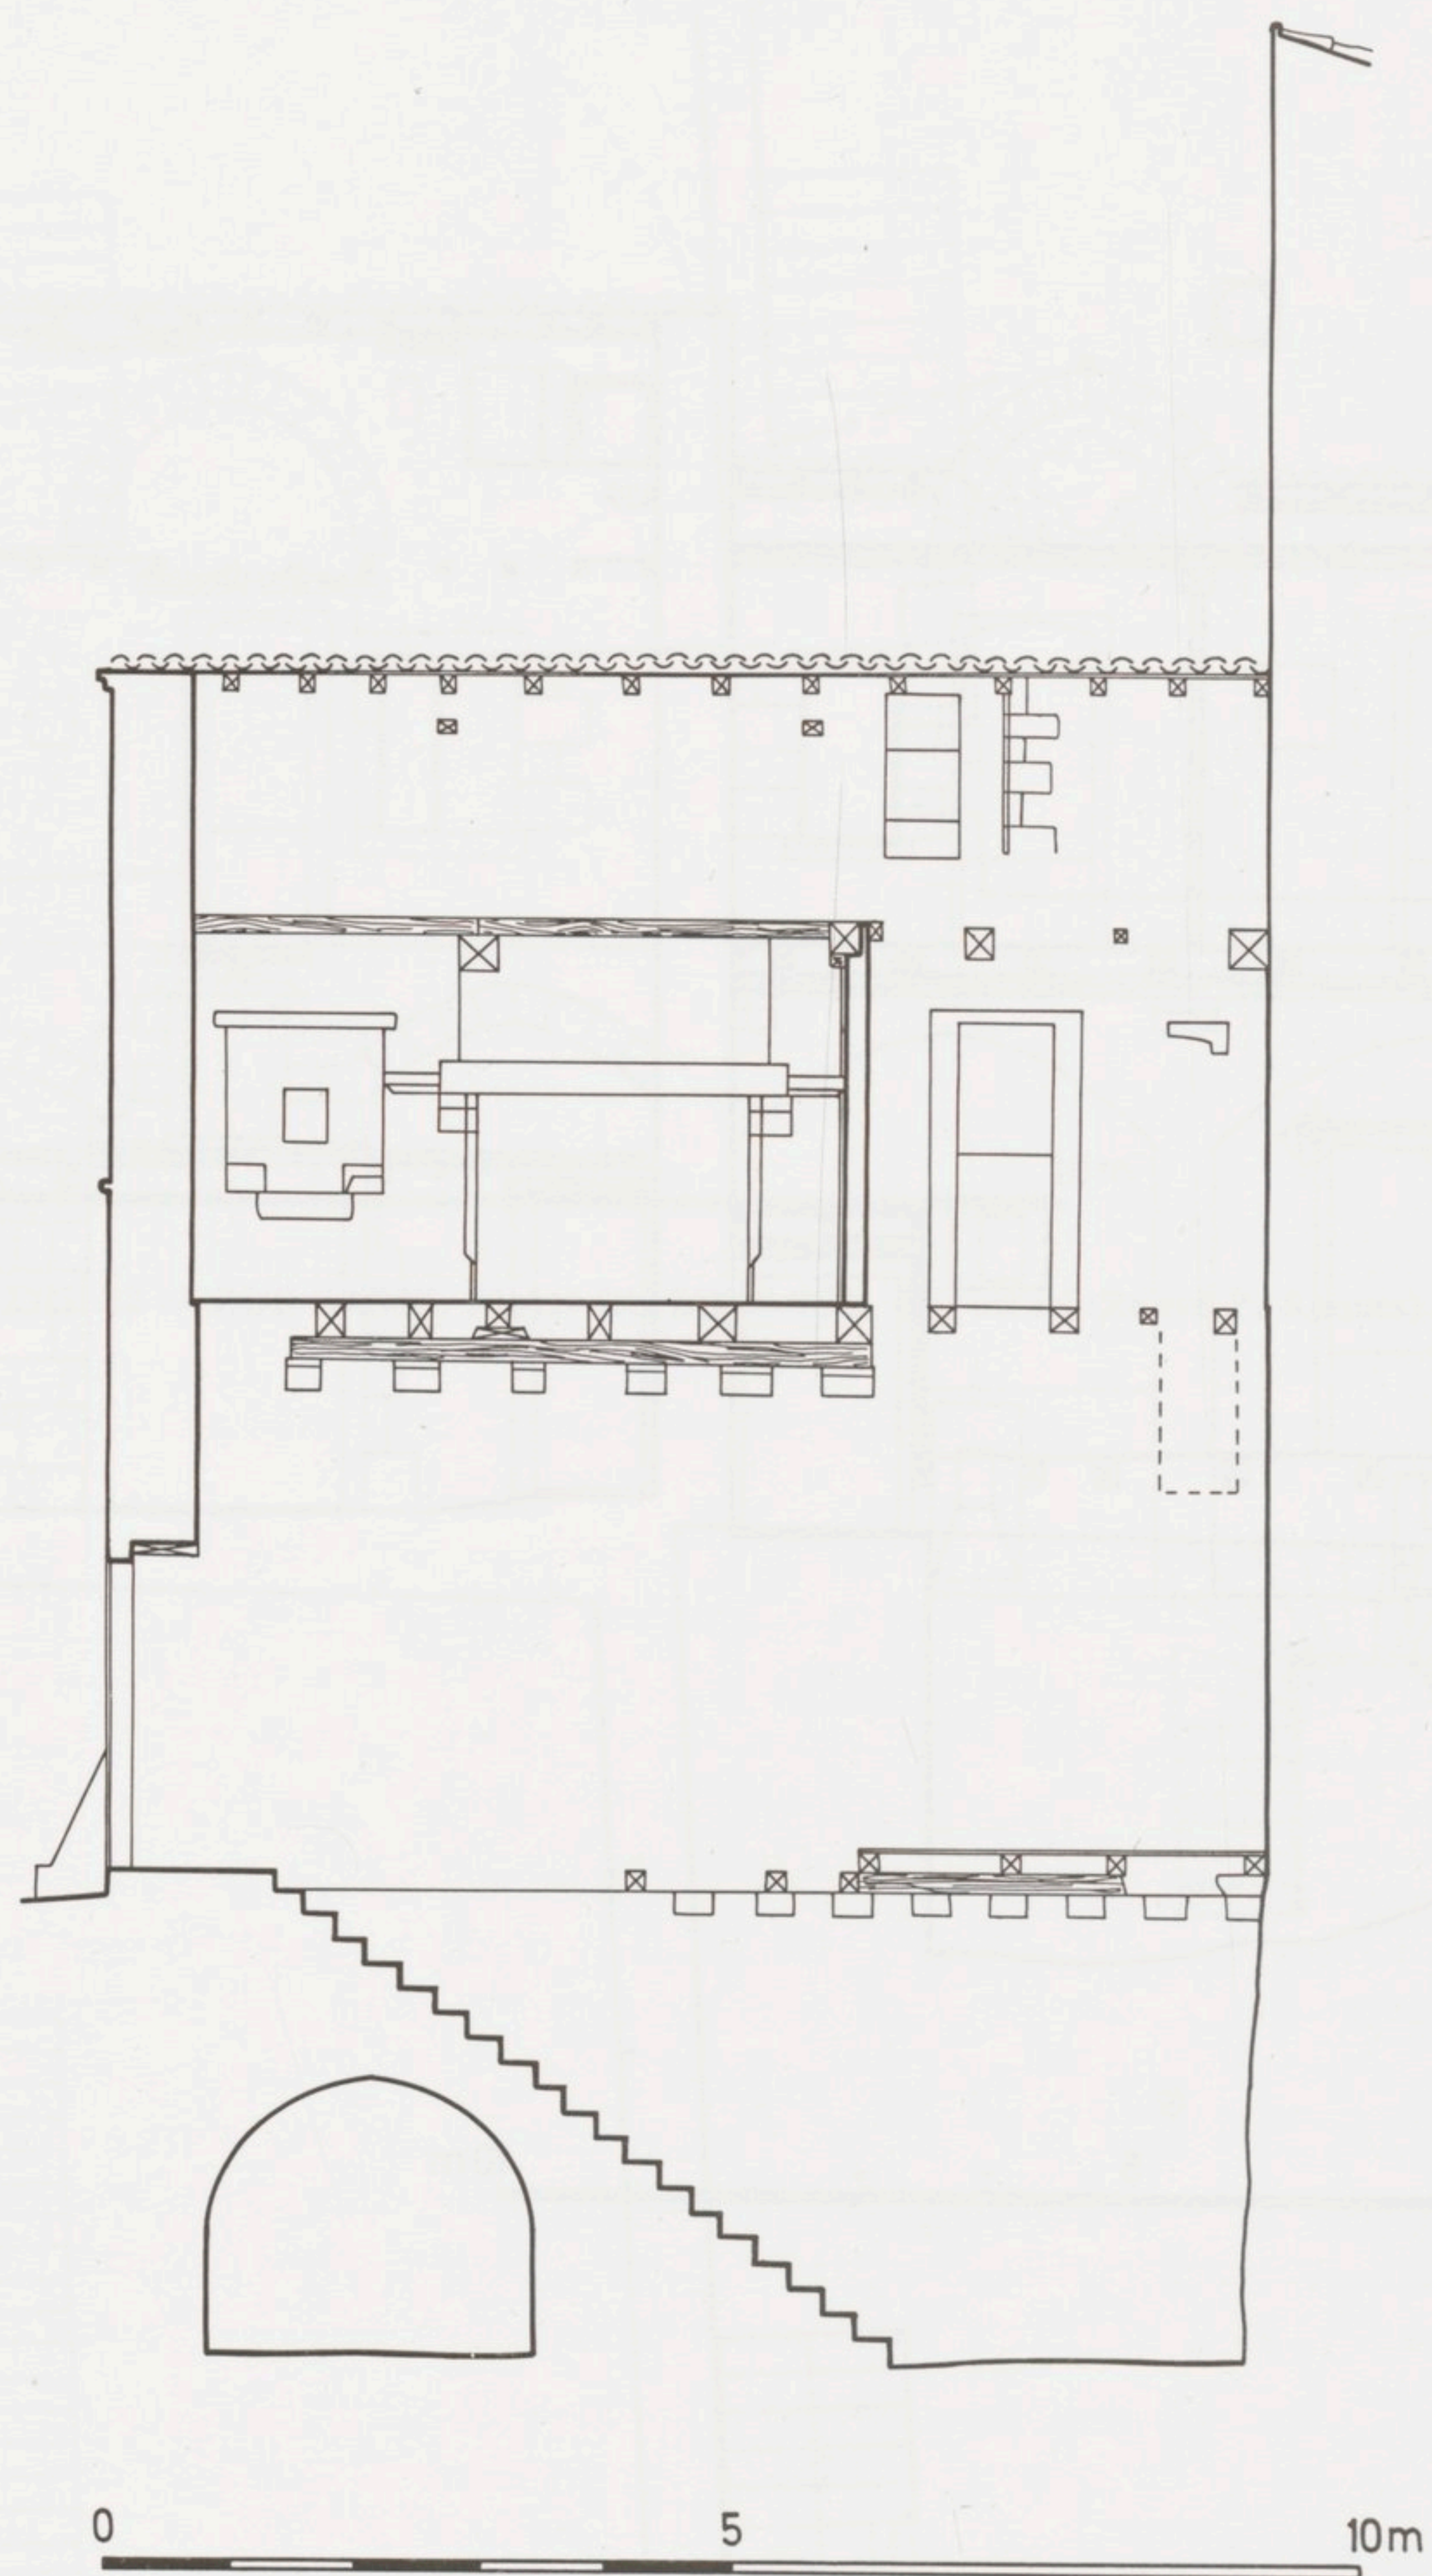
RUE BASSE, COUPE EST-OUEST ET ELEVATION INTERIEURE DU MUR SUD, état actuel (Relevé P. Roques).
